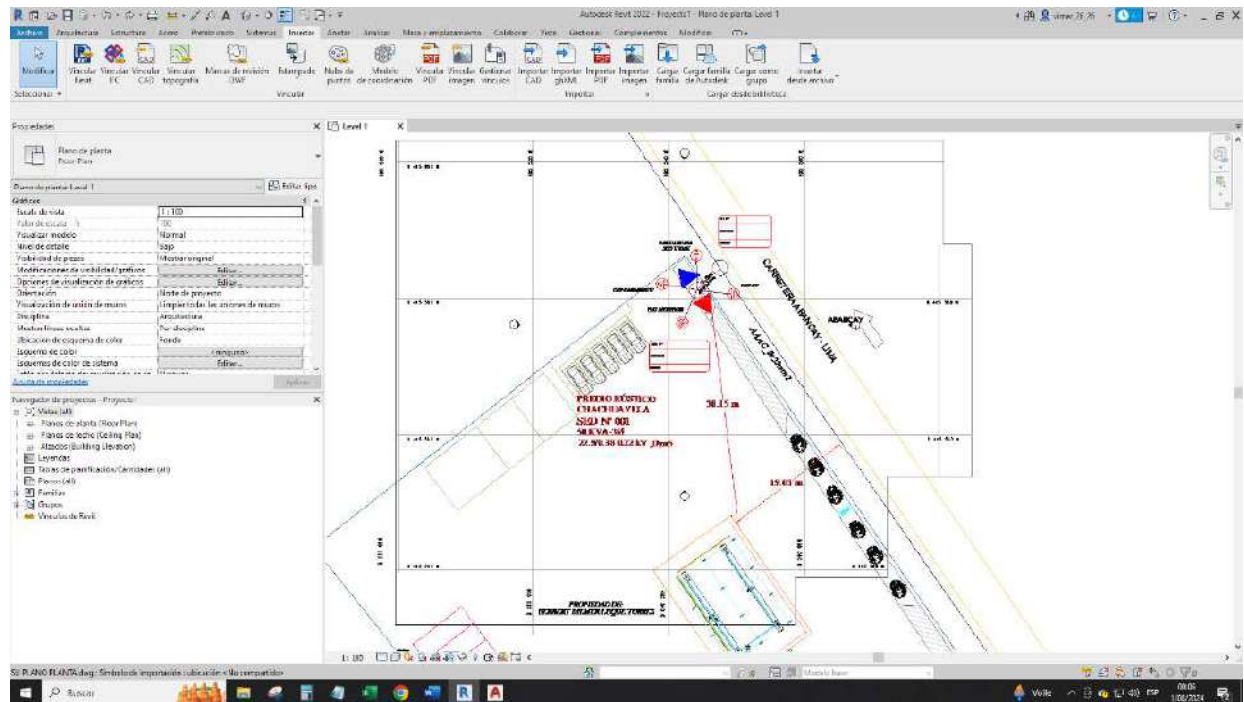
Planimetría de la Red Primara del Proyecto y Diagrama Unifilar
